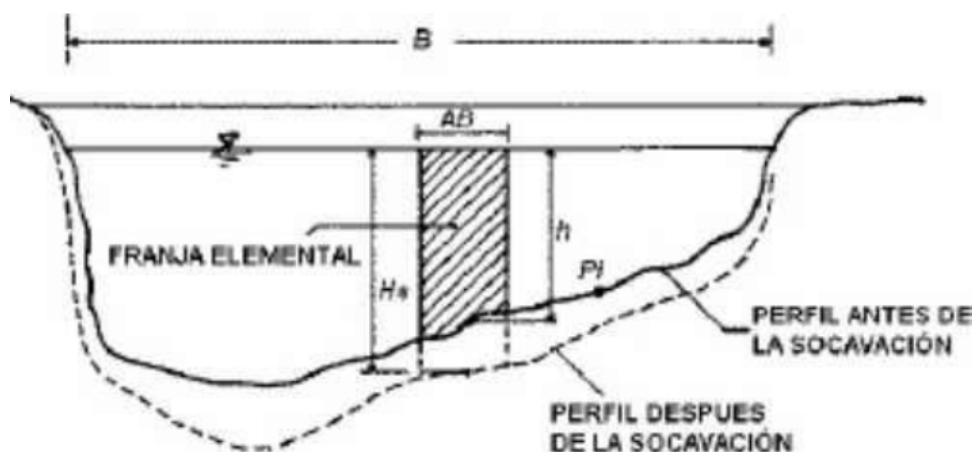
Sección transversal de un cauce afectado por socavación.
